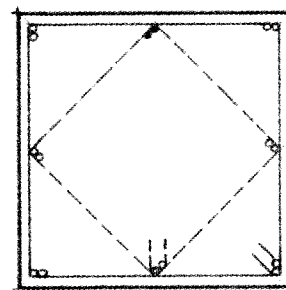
Columna armada con paquetes de varillas y estribos.
